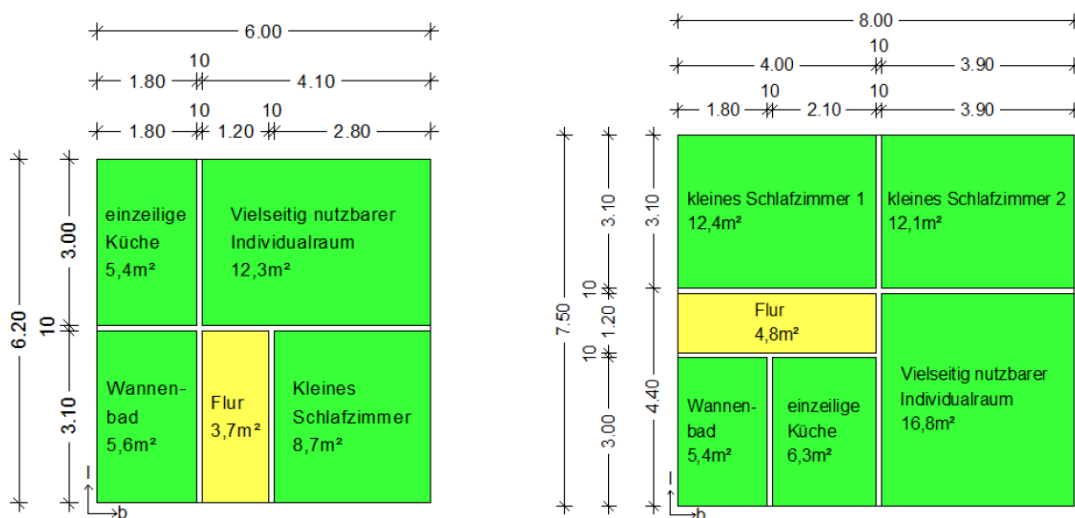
Grundriss 1 (links) und Grundriss 2 (rechts)
